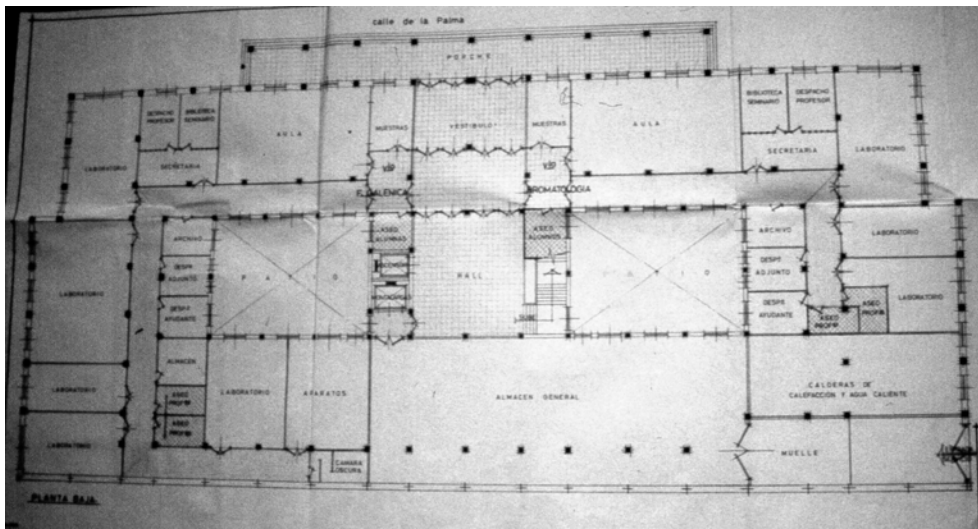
Proyecto de Facultad de Farmacia: planta baja, por Antonio García Lozano, julio de 1974.
